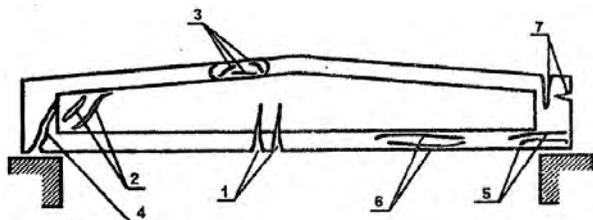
Трещинообразование в предварительно напряженной стропильной балке
